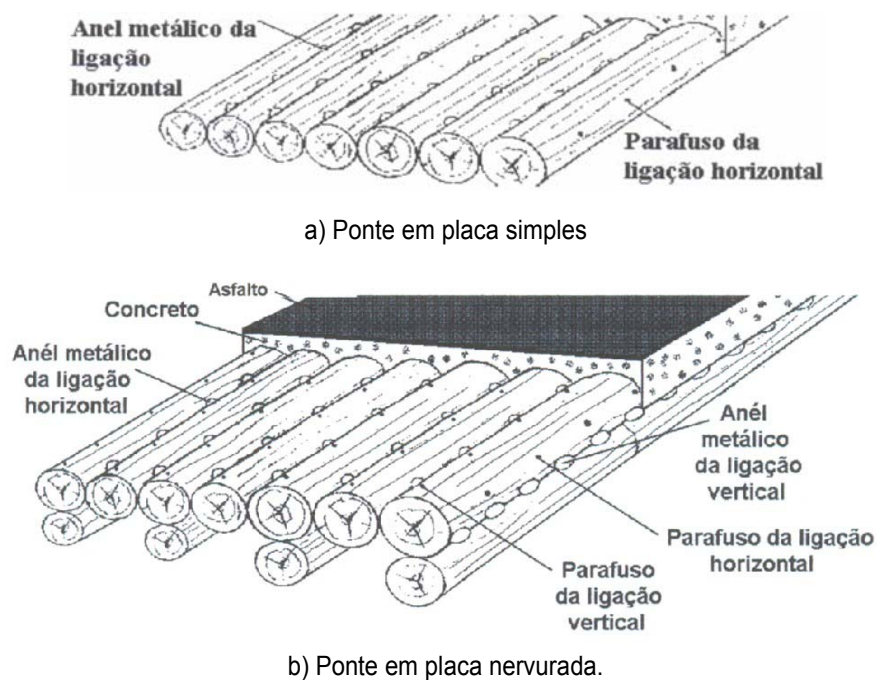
Pontes em placa mista com peças roliças de madeira e concreto armado.
